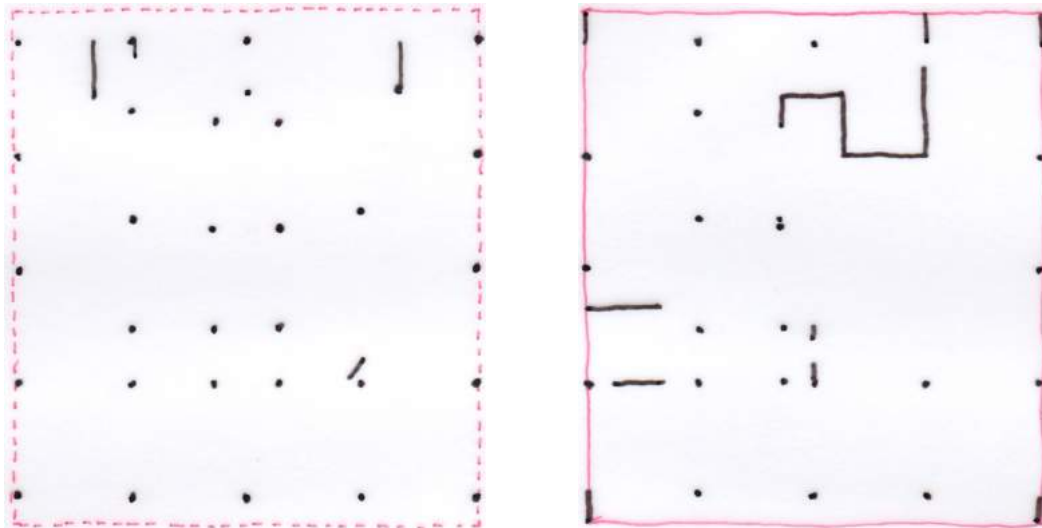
Schéma de la structure verticale du premier niveau et du rez-de-chaussée.
